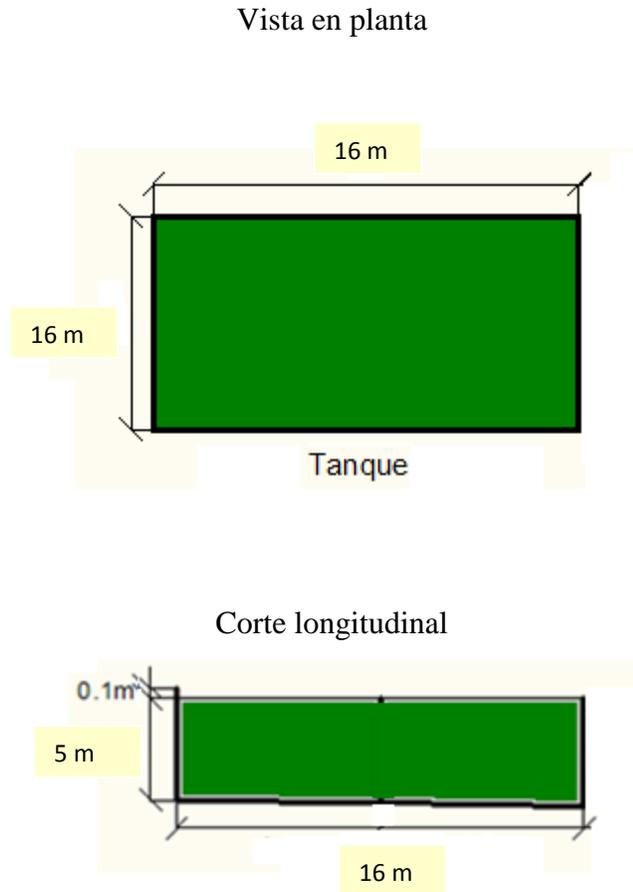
Vista en planta y corte longitudinal del Canal con Buchón de Agua.
